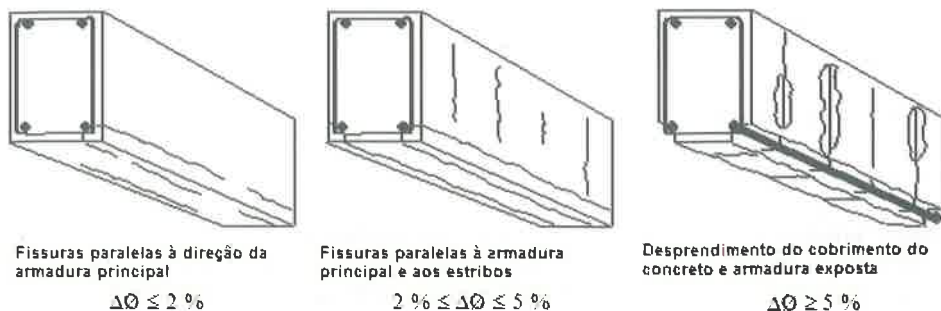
Representação esquemática das patologias típicas observadas em vigas de concreto armado afetadas por corrosão
